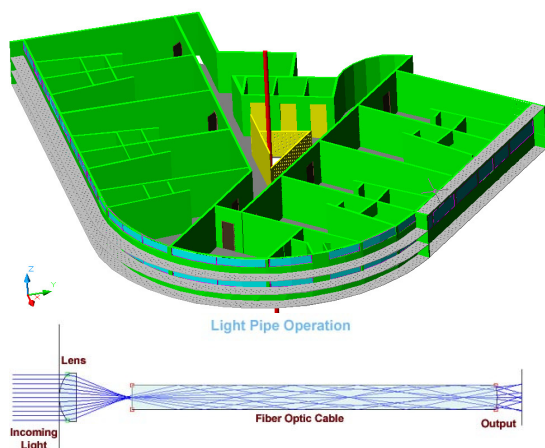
Perspectiva de pavimento tipo - Detalhe de tubulação para iluminação natural em átrio.
